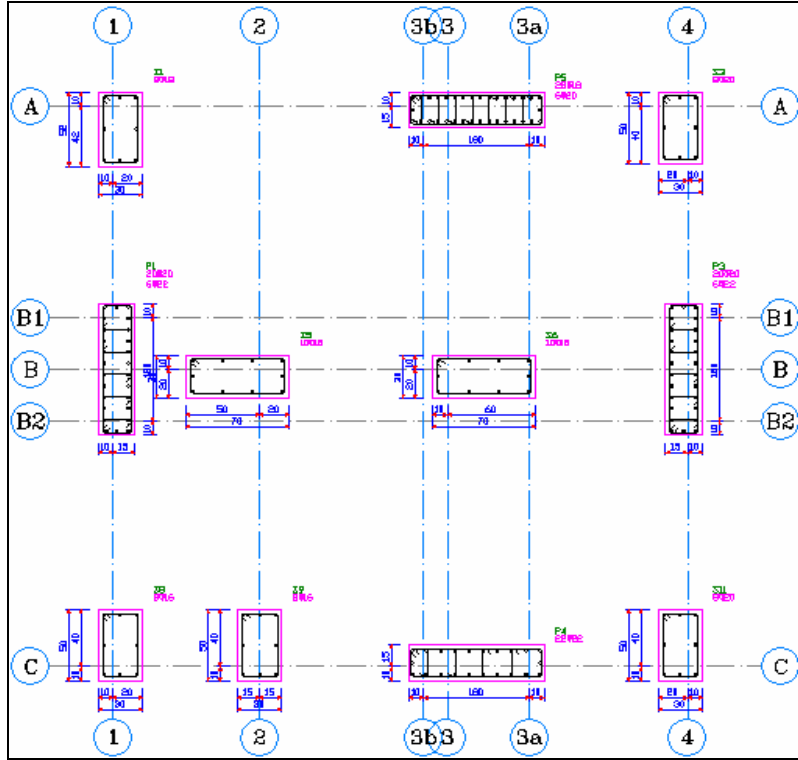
Kirişli döşemeye sahip 8 katlı betonarme perdeli - çerçevesi yapının kolon aplikasyonu
